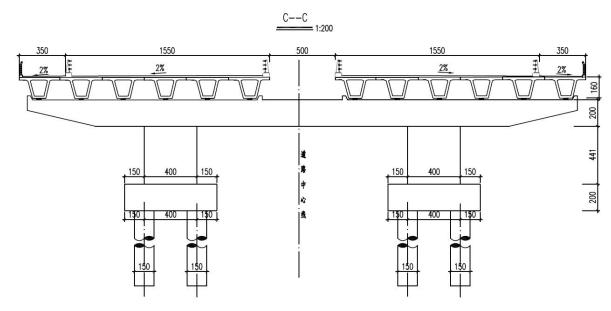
引桥箱梁横断面布置图 (详见附图 10)
